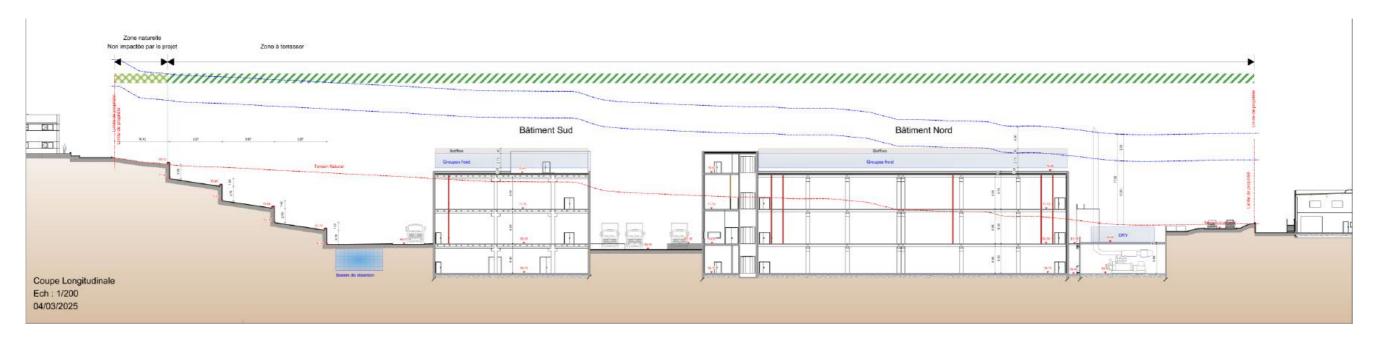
Plan de coupe des excavations nécessaires au droit du site pour la réalisation du projet d'aménagement (Source : TELEHOUSE, le 4 mars 2025)
